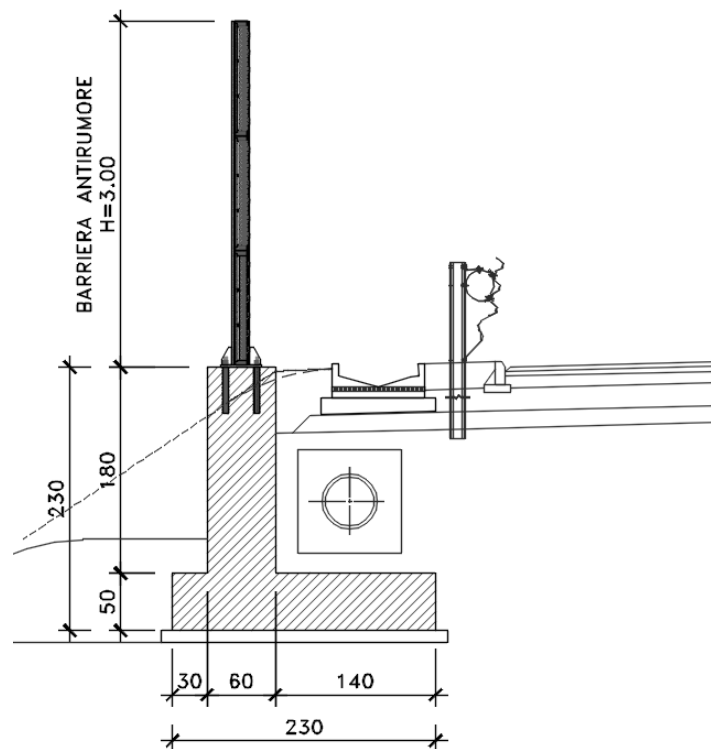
Sezione trasversale strutture di mitigazione acustica e opere di fondazione.
